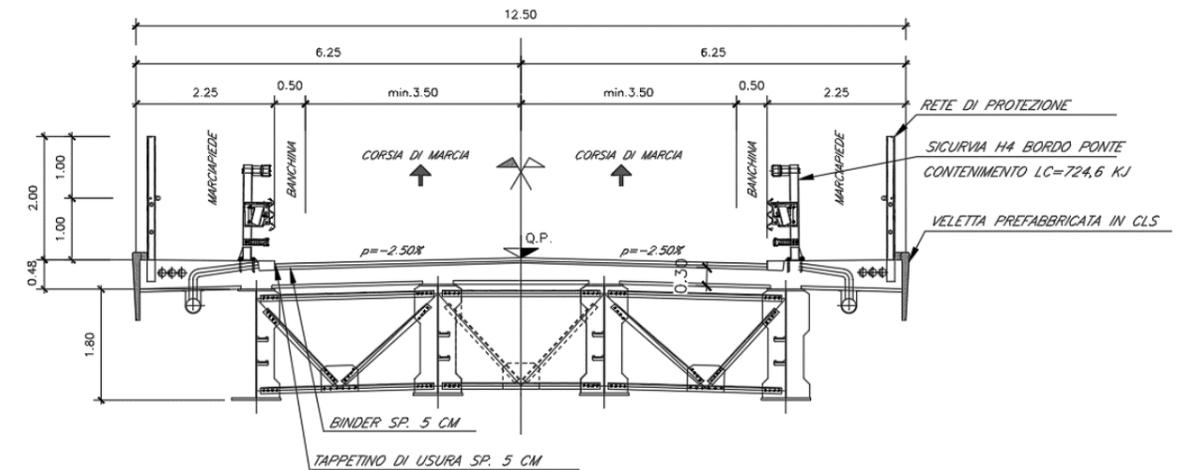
Sezione tipo dell'impalcato metallico dell'IV01
